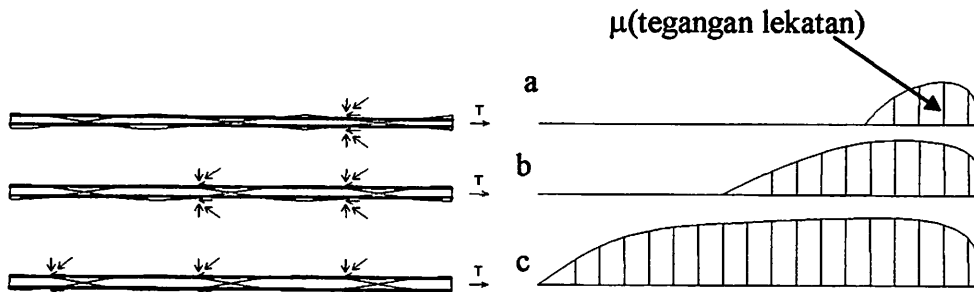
Panjang tulangan (ld) yang tertanam dalam beton
